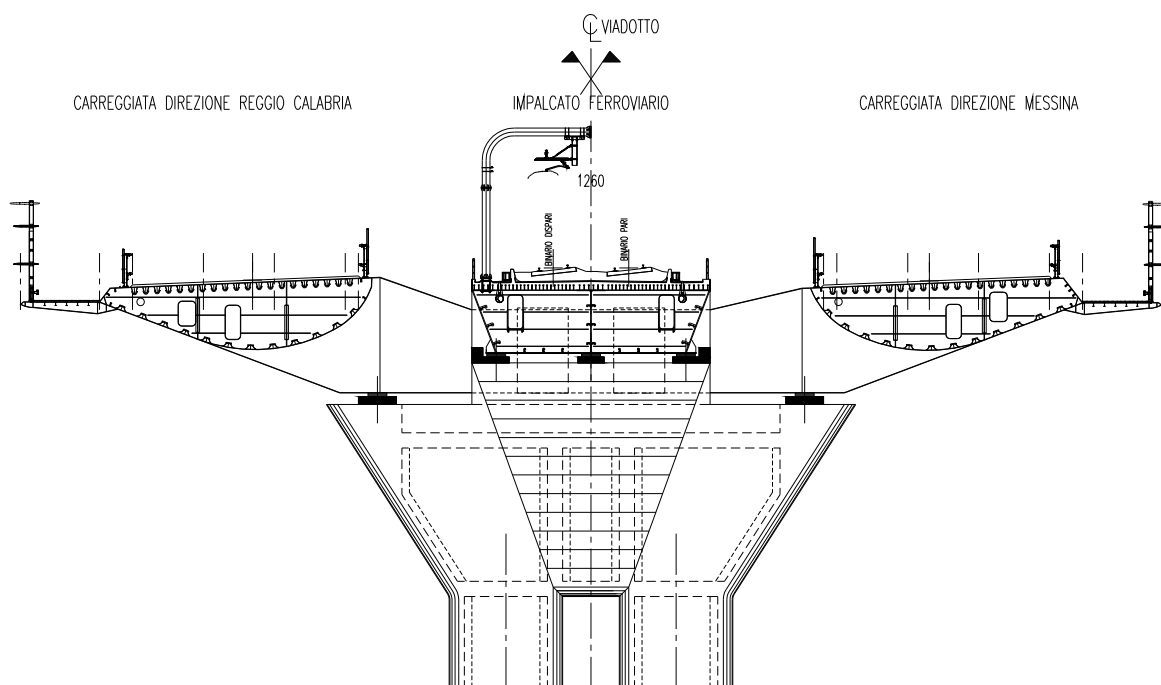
sezione trasversale dell'impalcato ferroviario e stradale in corrispondenza della pila
